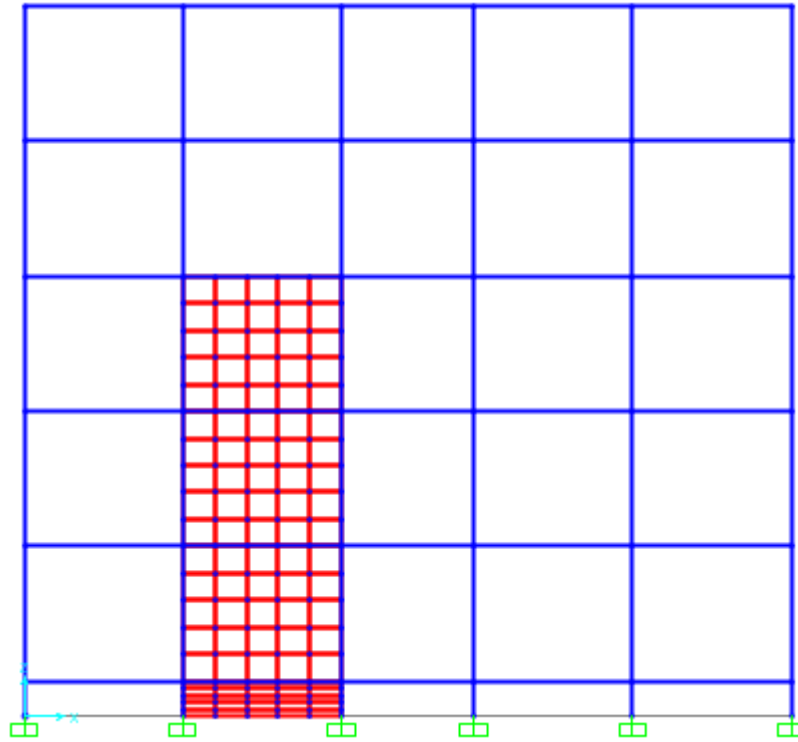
Ajout des voiles sur RDC+ 2 étages
